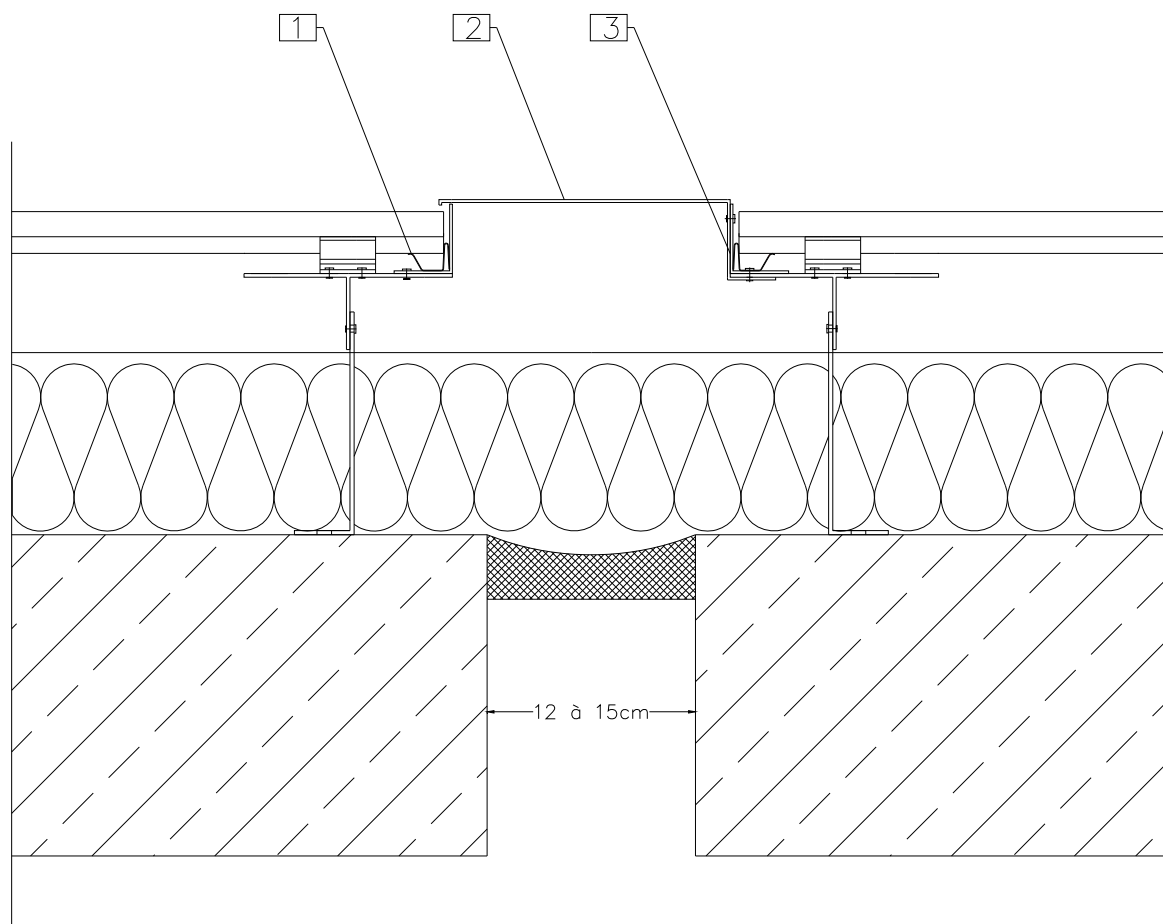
Fractionnement de l'ossature au droit de chaque plancher sur béton
